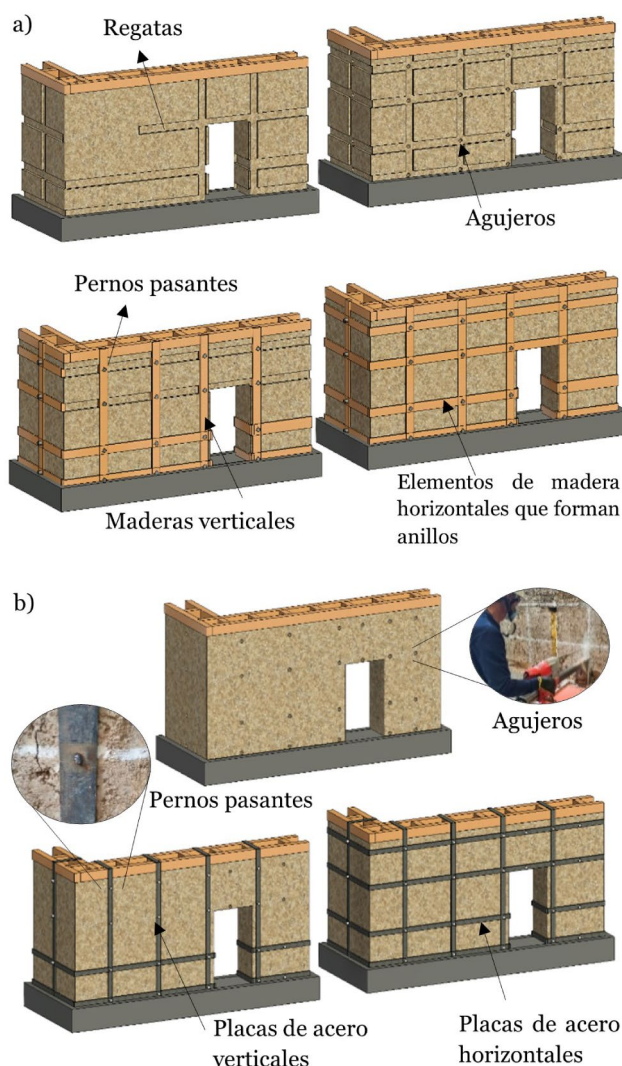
Proceso de reforzamiento con a) con entramados de madera b) placas de acero.
